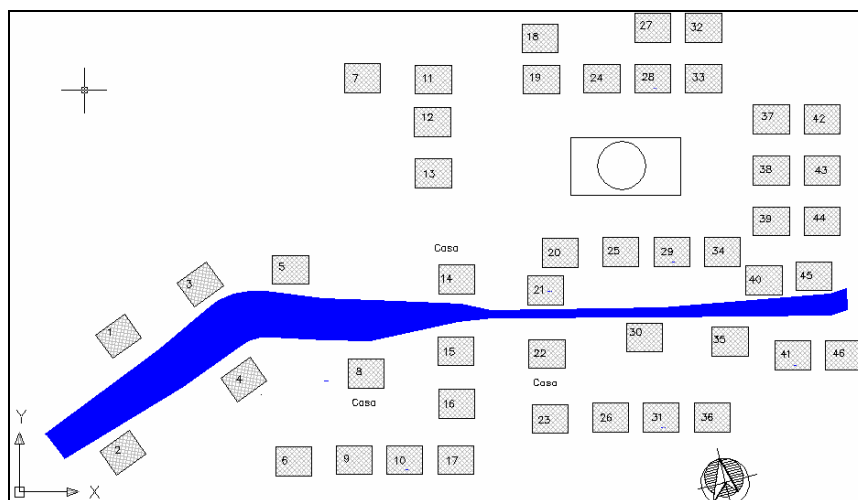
Planimetría de la localidad (columna 1 de la tabla 1.19)
